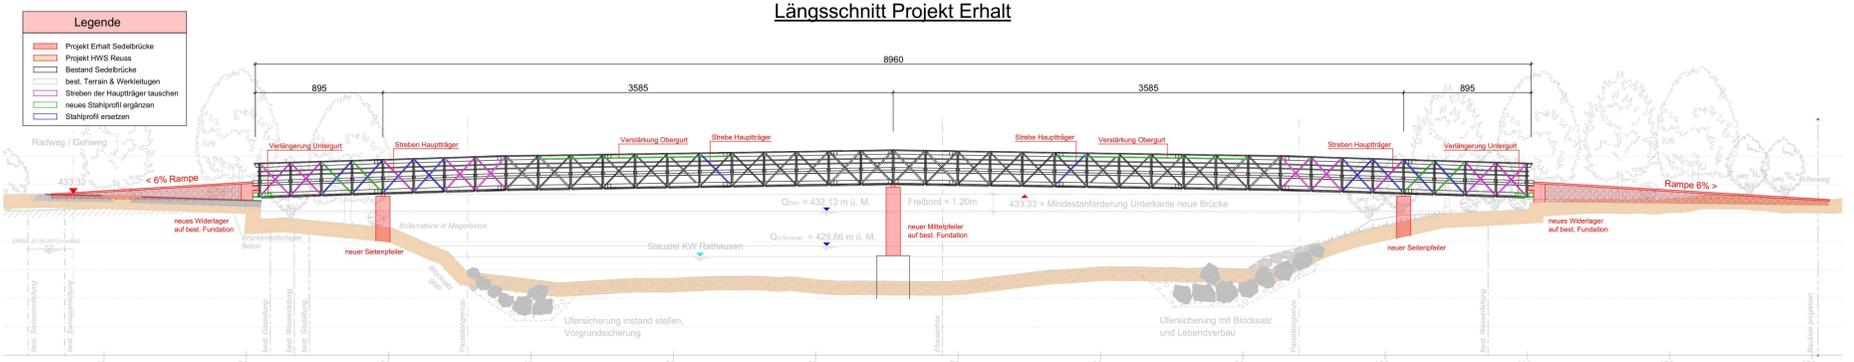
Längsschnitt Projekt Erhalt Sedelbrücke (nach IG Reuss-Auen, 2019)
